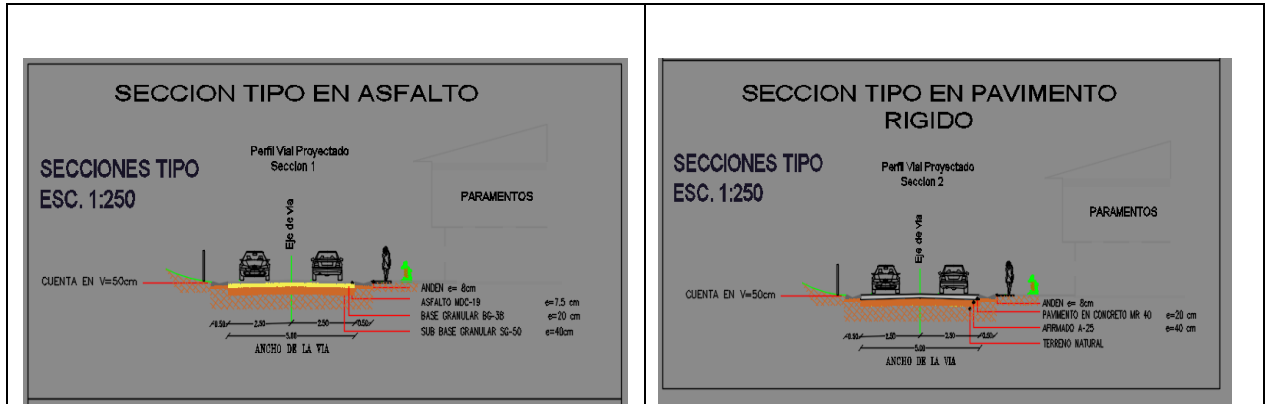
Esquema estructura pavimento flexible resultante.
